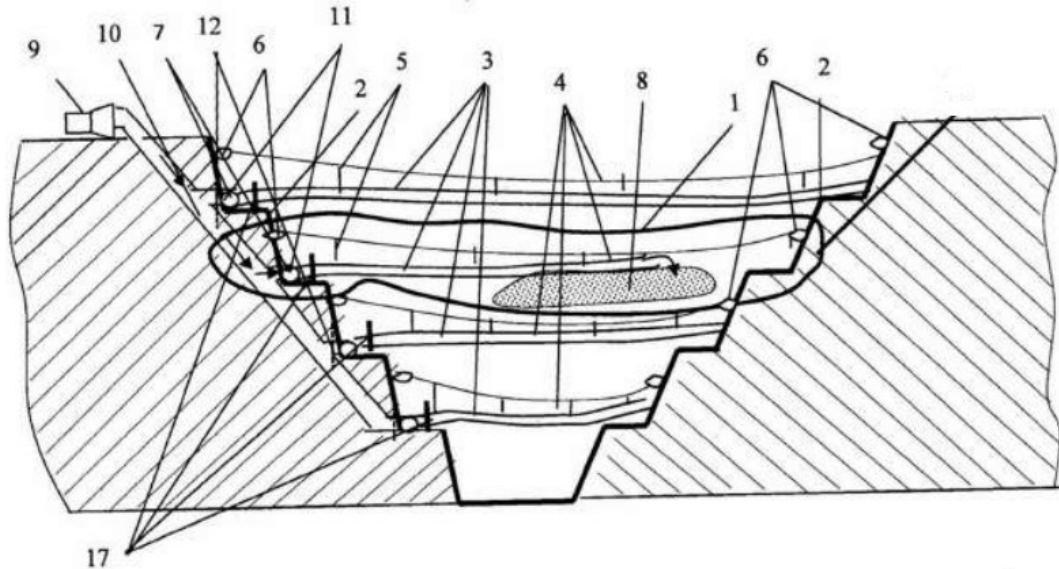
Вертикальный разрез карьера с трубопроводами для подачи воздуха, где:
